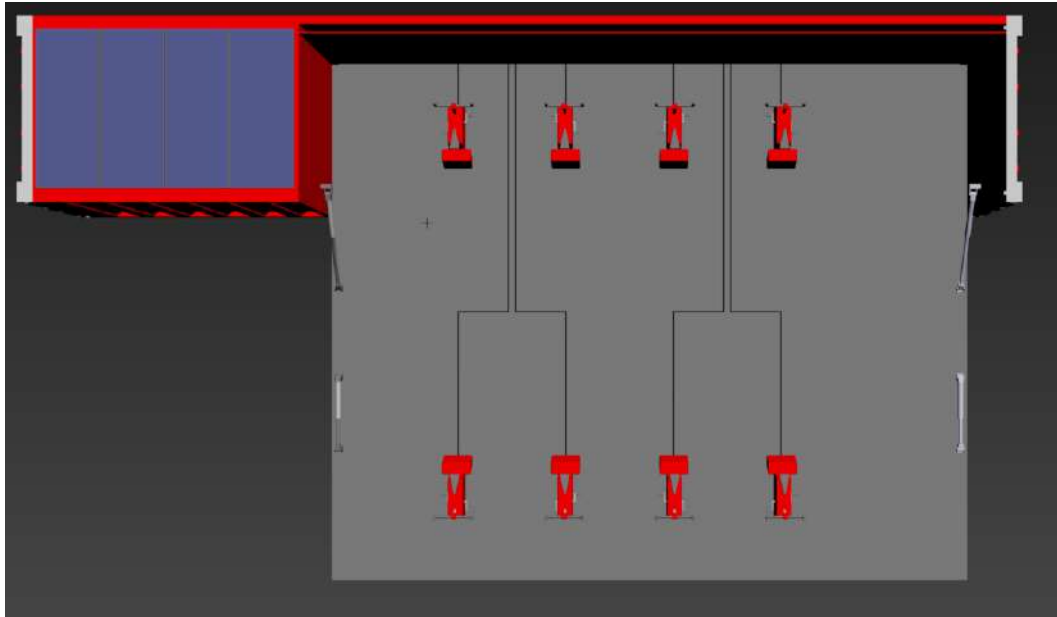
Render detalle cables container “Fuente: Elaboración propia”
